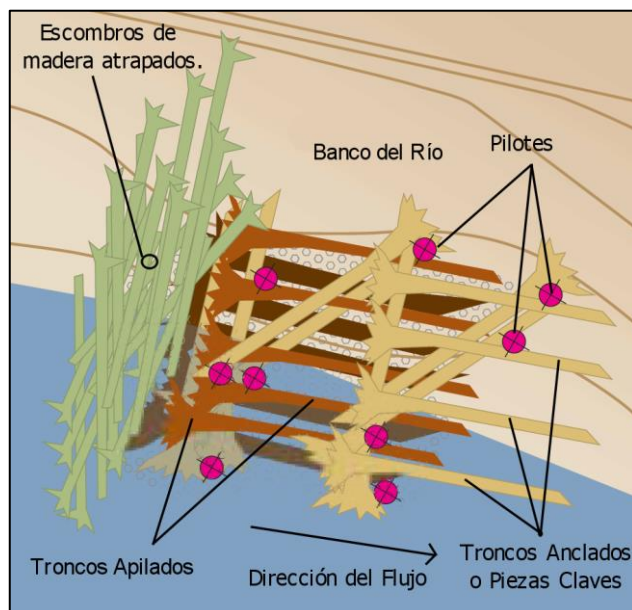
Vista en Planta de un Espigón Fabricado con Troncos de Árboles.
